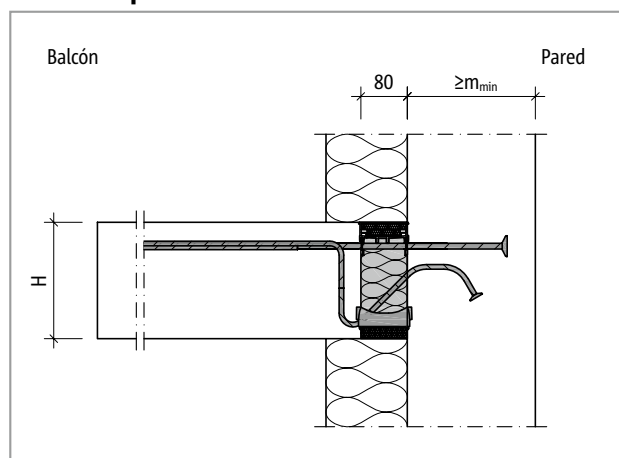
Schöck Isokorb® T tipo K-U: Conexión a pared hacia arriba en caso de aislamiento externo
